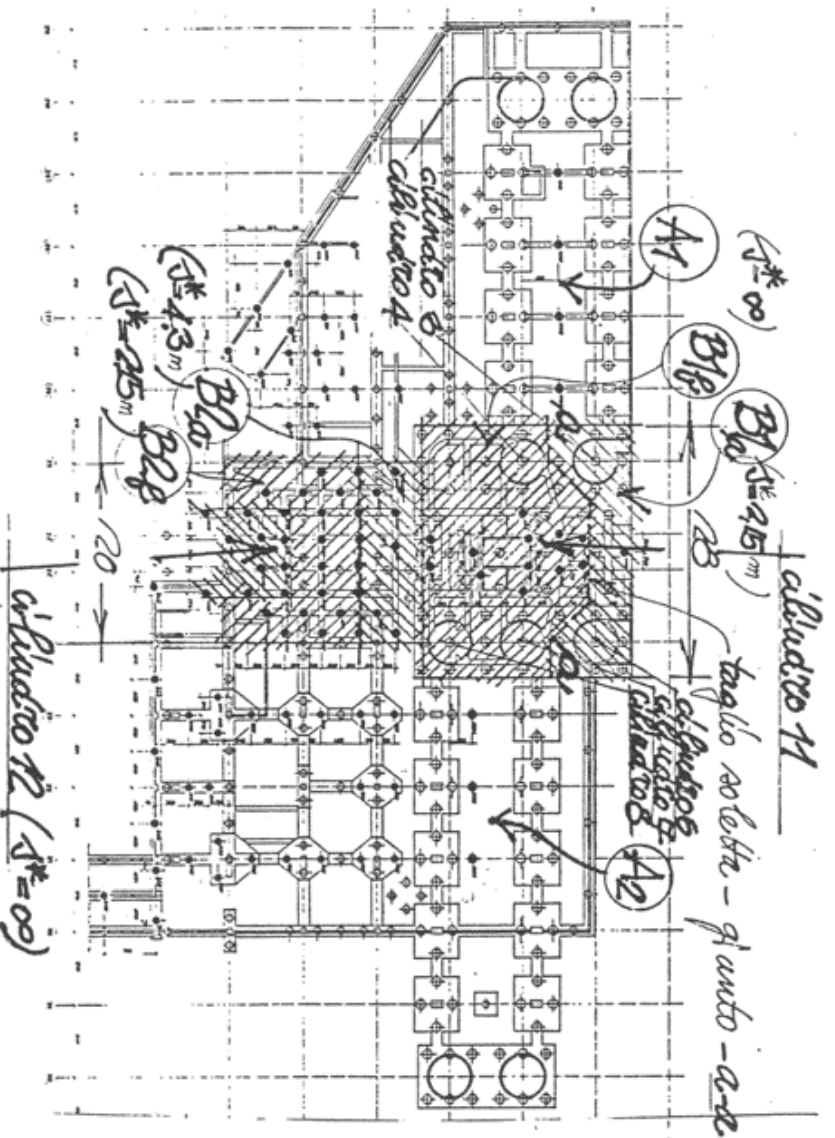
Individuazione delle strutture di fondazione e delle zone B1 e B2
